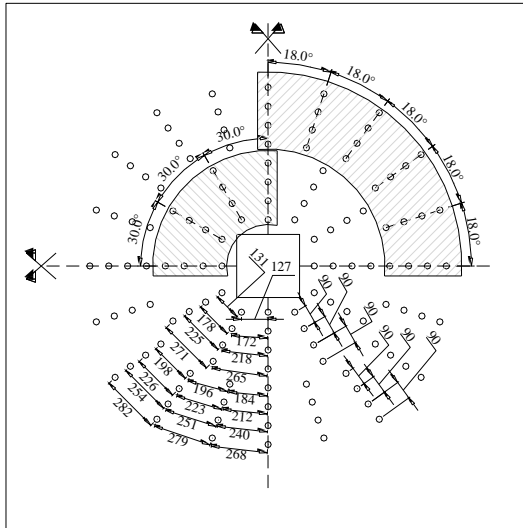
Posição dos furos - Laje LR-S2-8
